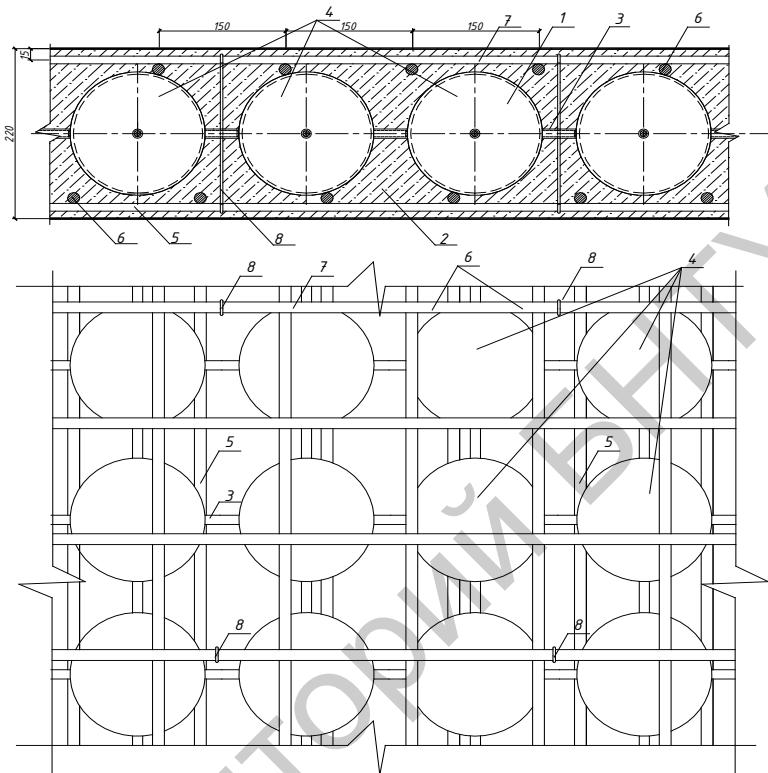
Схемы устройства пустотообразователей в плитах перекрытия; 1–пустотообразователь; 2 – плита перекрытия; 3 –фиксаторы; 4 – блок пустотообразователей; 5– нижняя арматурная сетка; 6 – арматурные стержни; 7 - верхняя арматурная сетка; 8 – хомуты.
